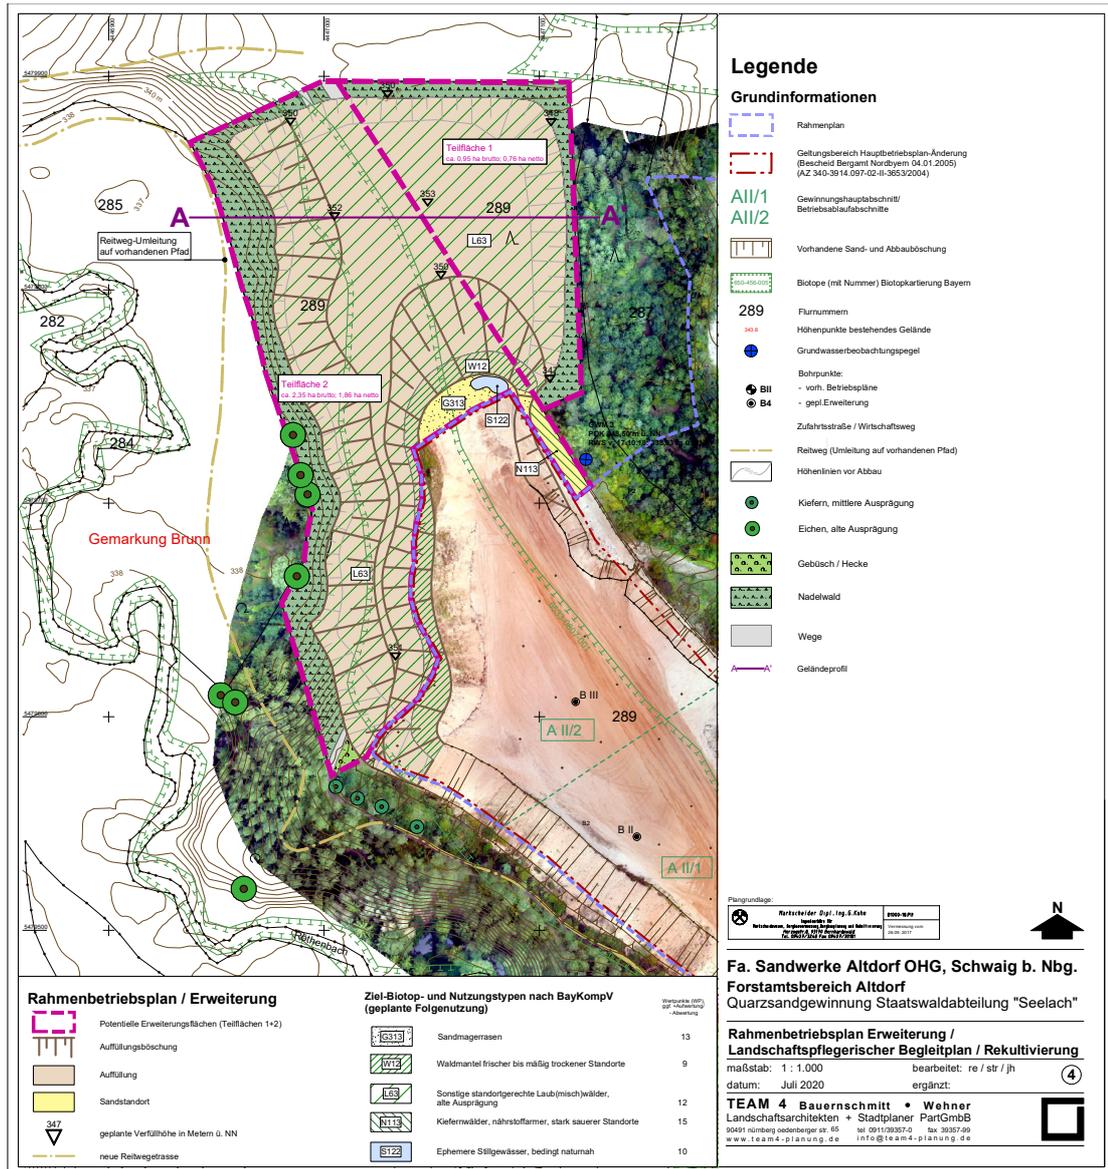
Lageplan mit Erweiterungsbereich des Rahmenbetriebsplans (violett) (Team 4, Juli 2020)
